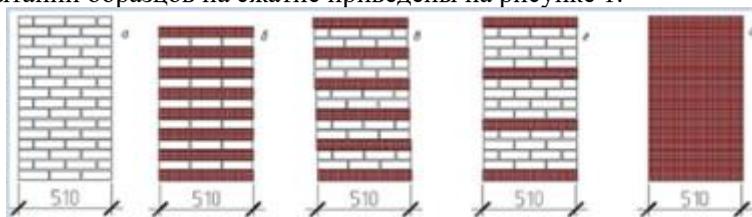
Схемы армирования композитными сетками при испытании образцов на сжатие
